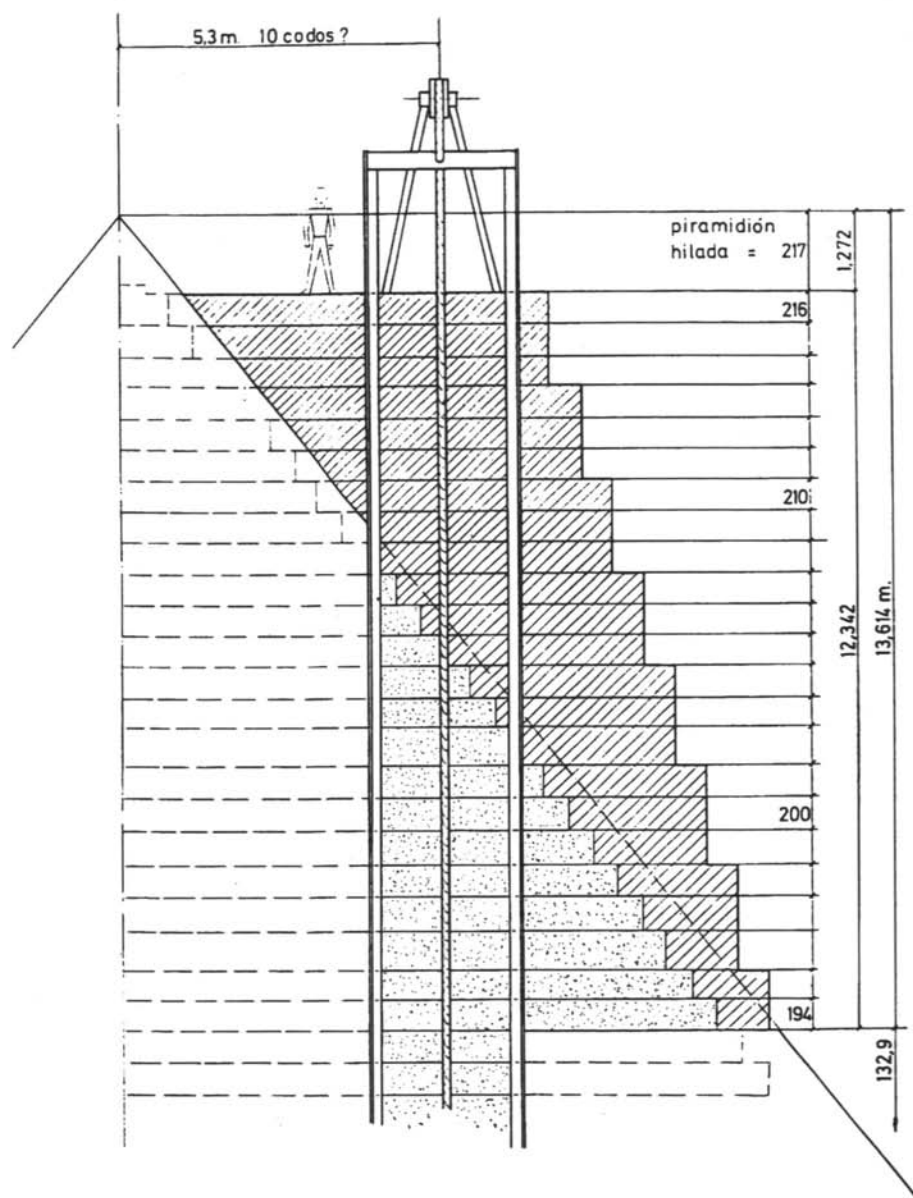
Terraza auxiliar adosada sobre la fachada Este.
